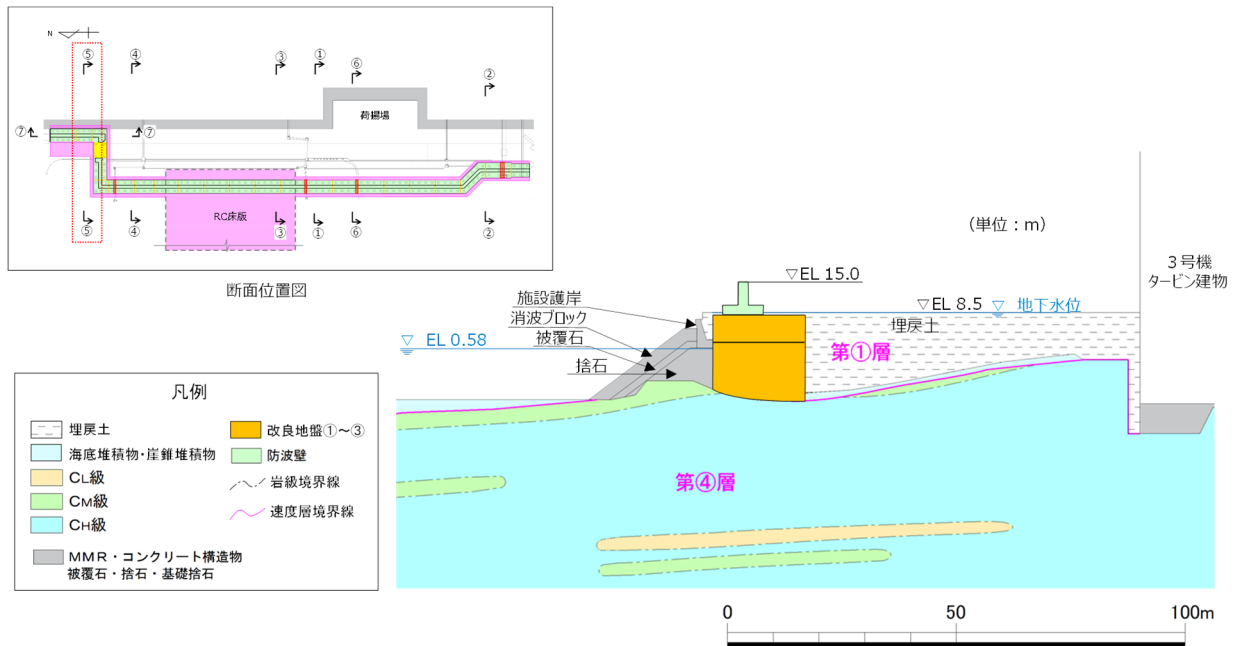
地質断面図 (⑤-⑤断面)
